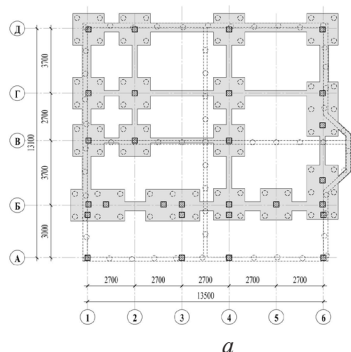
Схема расположения ростверков и групп из буронабивных железобетонных свай, выполненных при реконструкции фундамента
